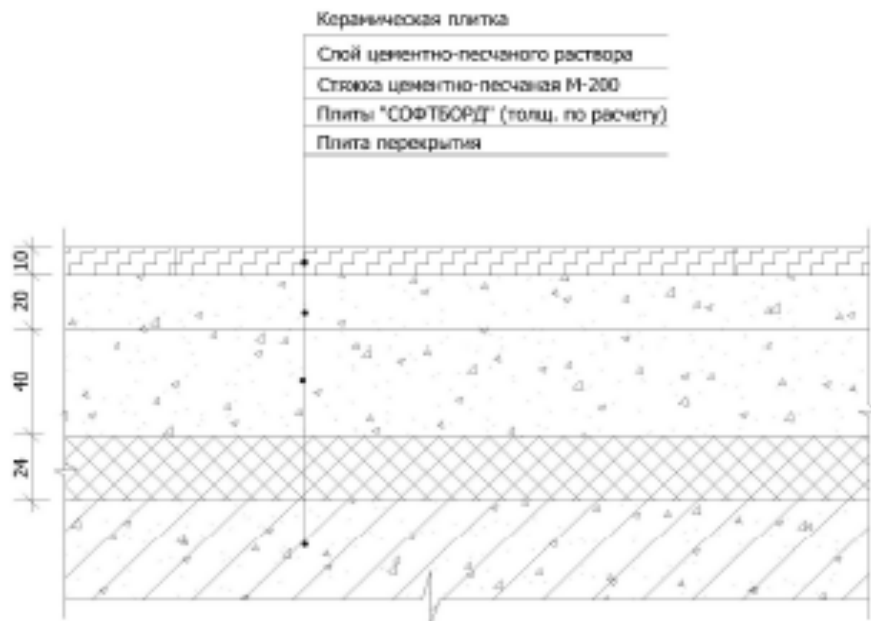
Применение плит СОФТБОРД с керамической плиткой. По ж/б междуэтажному перекрытию
